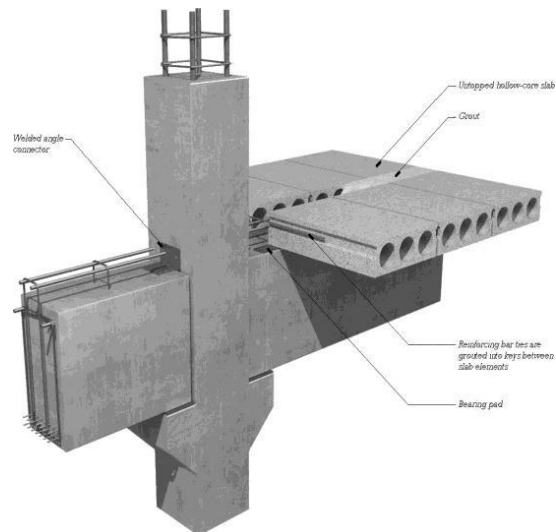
Sambungan antara kolom dan balok pracetak
